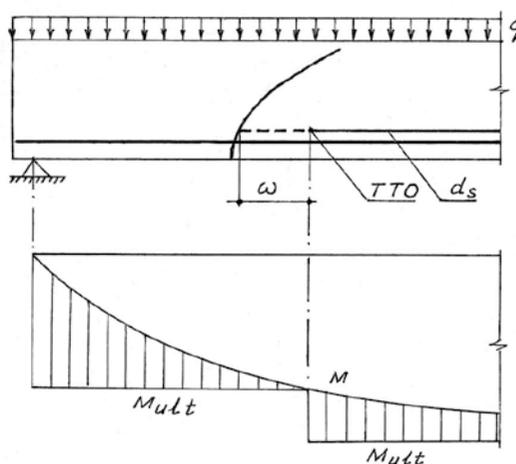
К расчету наклонных сечений на момент в местах обрыва продольной арматуры:  $M$  — эпюра изгибающих моментов,  $M_{ult}$  — эпюра материалов (предельных усилий), ТТО — точка теоретического обрыва
